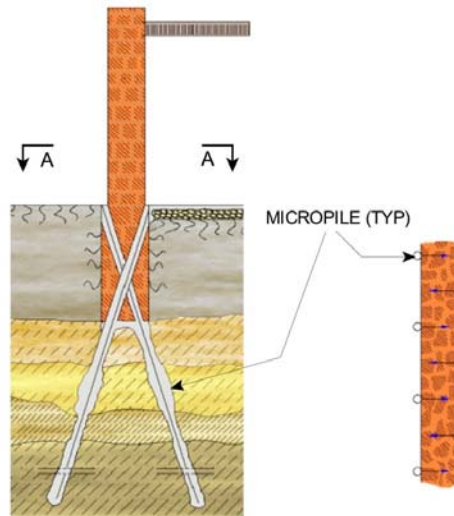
Усиление фундаментов буронабъекционными микроплощадями:
